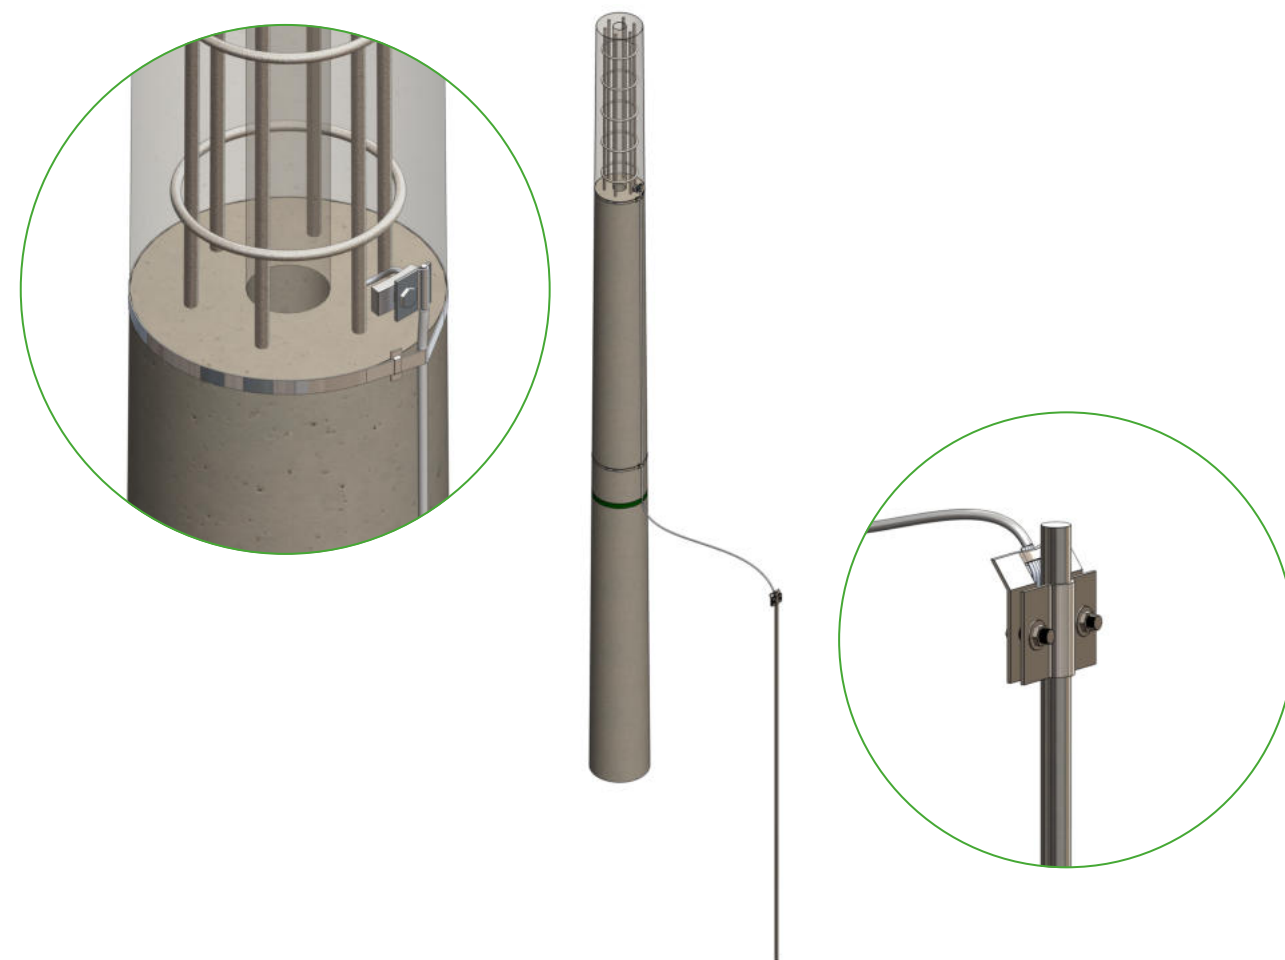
Elemento metálico de continuidad y conexión para puesta a tierra temporal en postes de concreto
